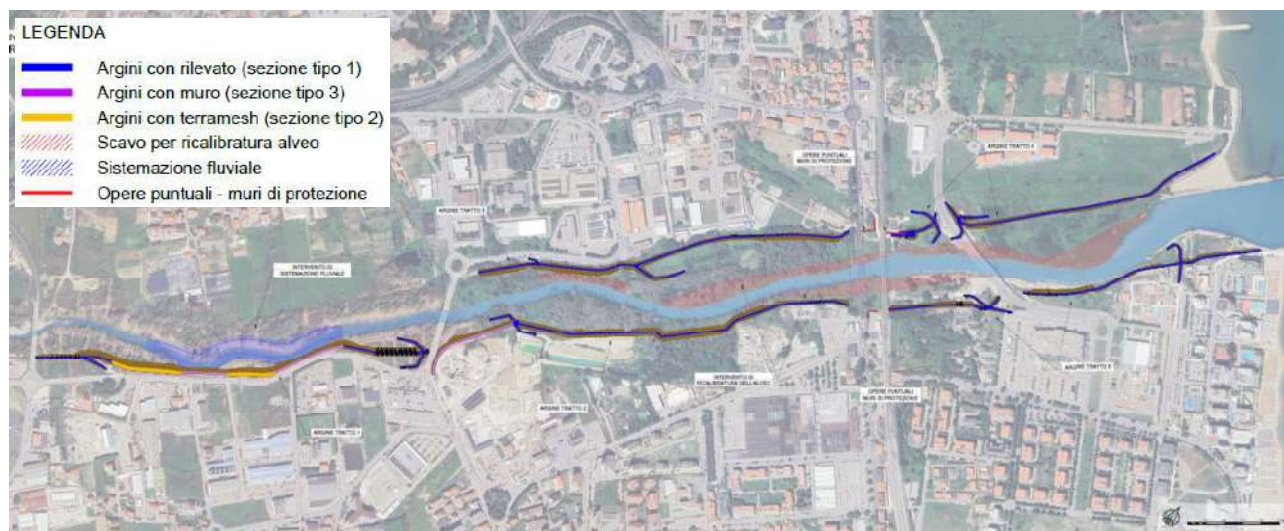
Stralcio planimetrico con gli interventi in progetto
